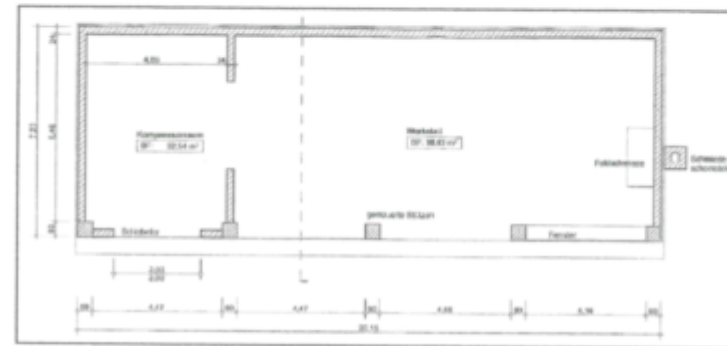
Grundriss Bildhauerwerkstatt (Quelle: Architekturbüro G. Eisold 2008)
